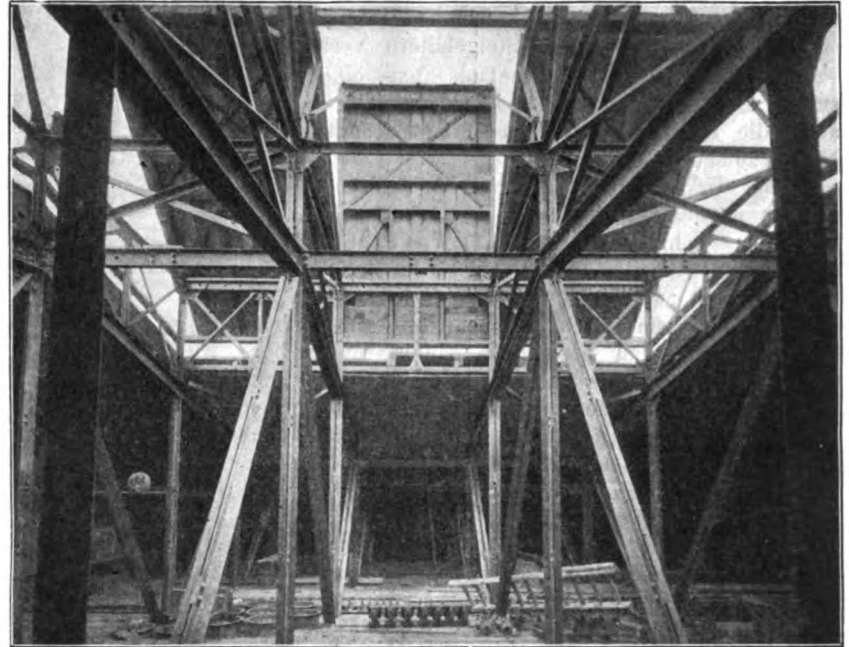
Eiserne Dachkonstruktion mit Rauchklappen.
